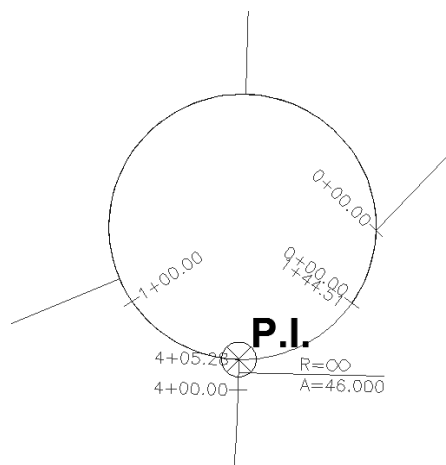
Intersecção em Planta entre o eixo do Restabelecimento 1 e a Rotunda A
